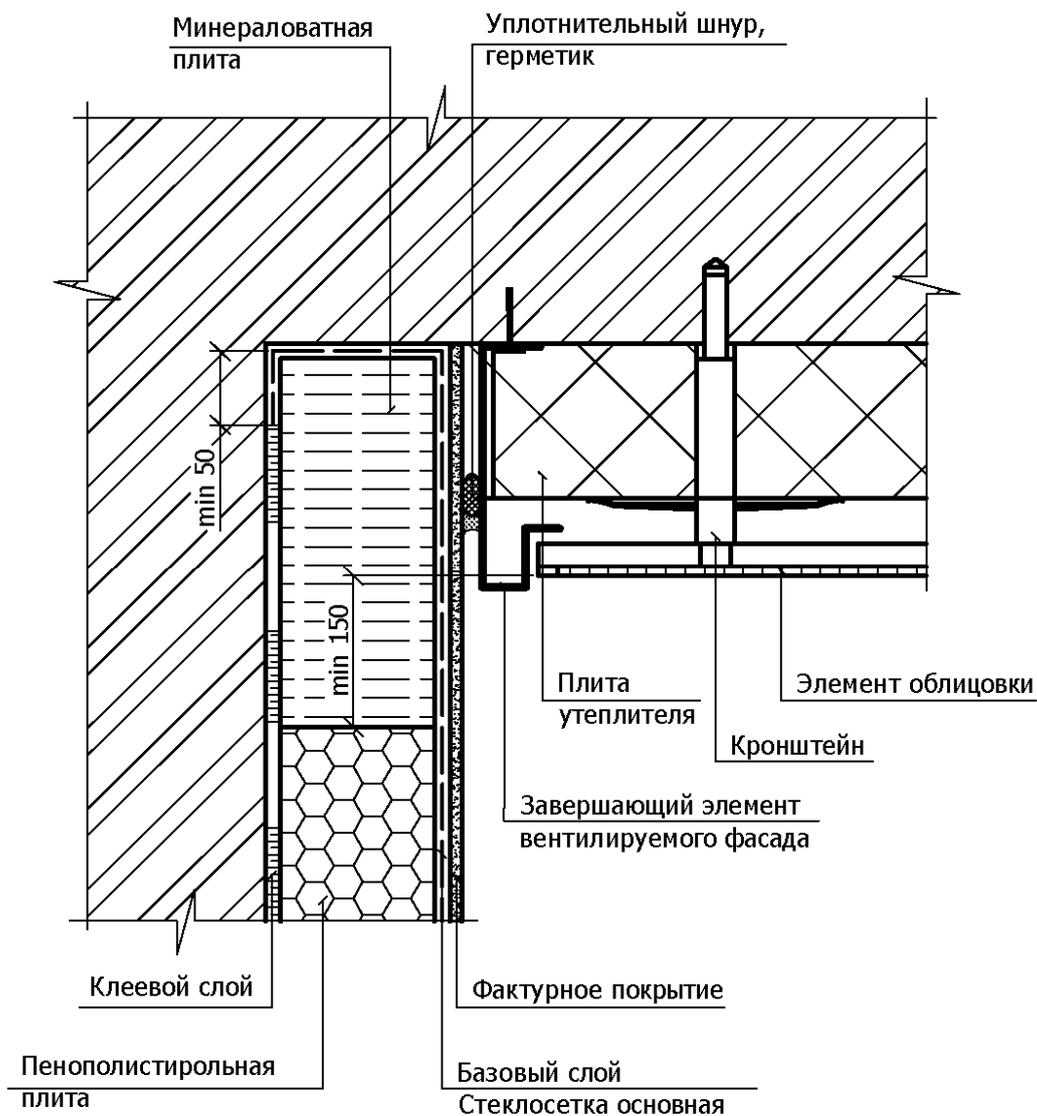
П Примыкание системы к вентилируемому фасаду на внутренних углах (вариант 1) ЛАЭС-П
